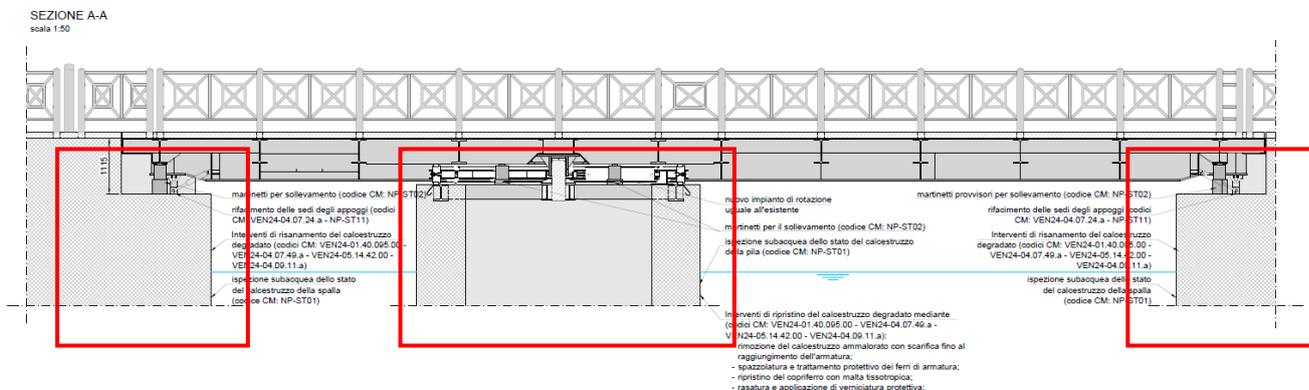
Prospetto con individuazione della pila e delle spalle.
